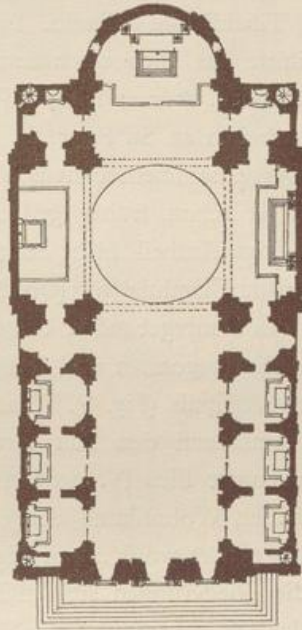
Grundriss der Kirche del Gesù in Rom.
